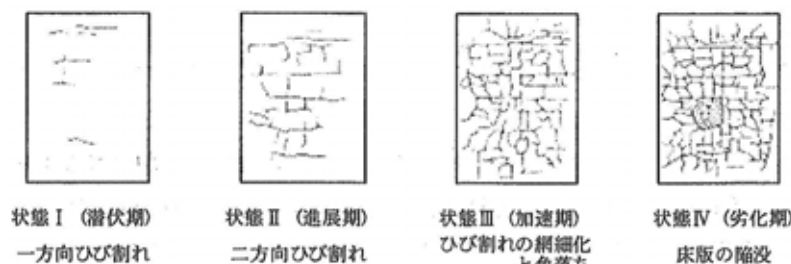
(3)-1 疲労による鉄筋コンクリート床版下面のひび割れ進行
